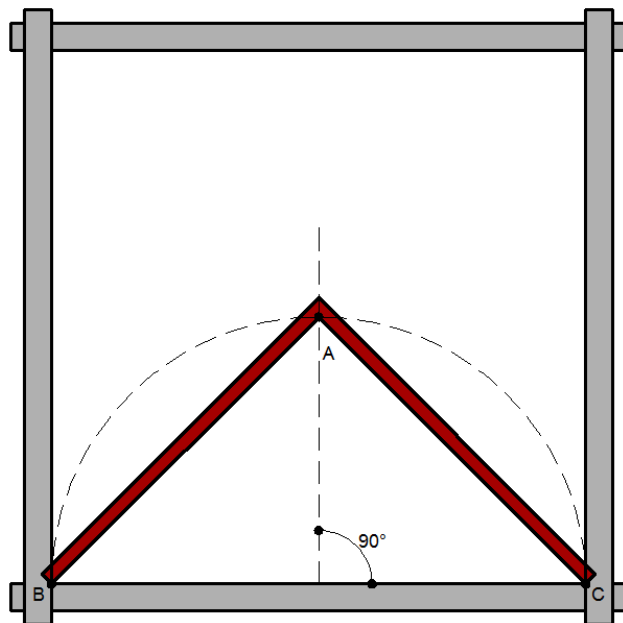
Vista en planta. Interpretación de la recomendación de Fray Andrés de San Miguel para las armaduras.
